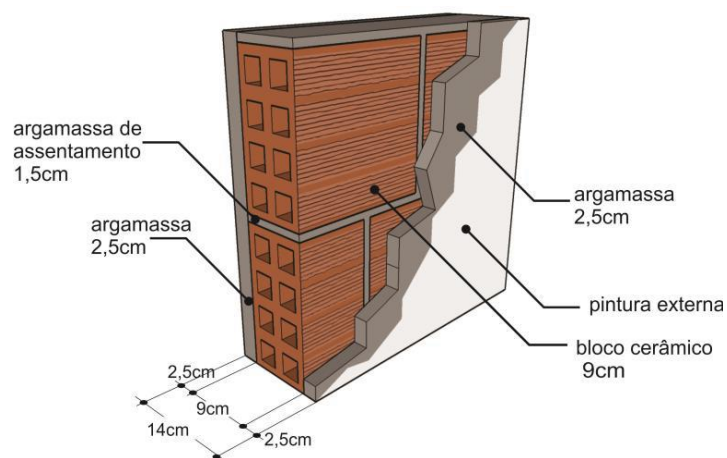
Características de parede em alvenaria de elevação em bloco cerâmico
